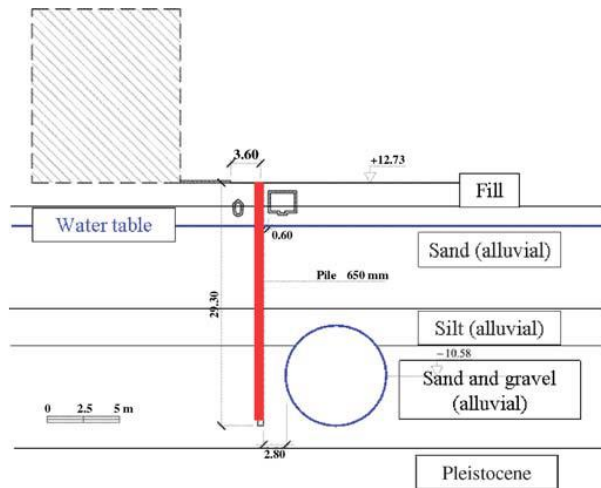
Vue en coupe du tunnel (métro ligne 9, Barcelone) et de l'installation de la paroi de protection. Di Mariano et al., (2007)
